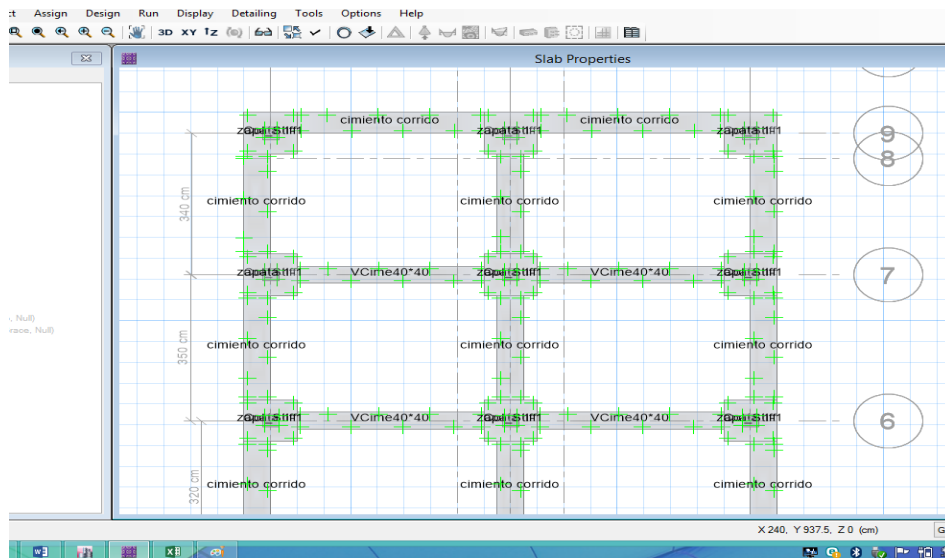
Vista en planta del plano de cimentación en SAFEv16
